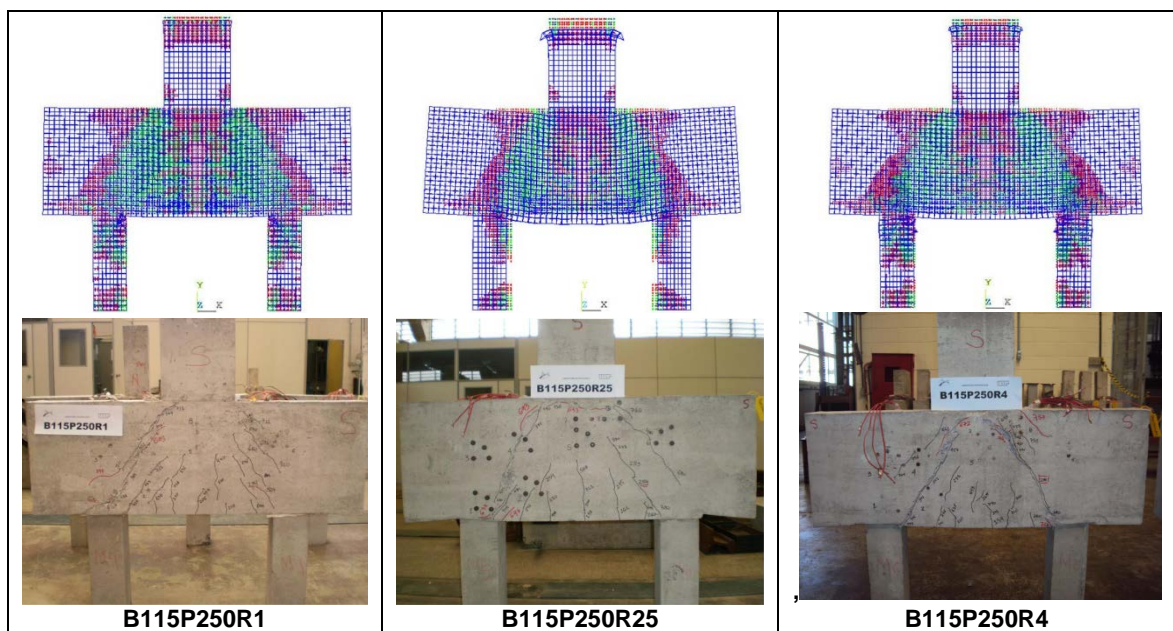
Configuração final de fissuras dos modelos da série B115
